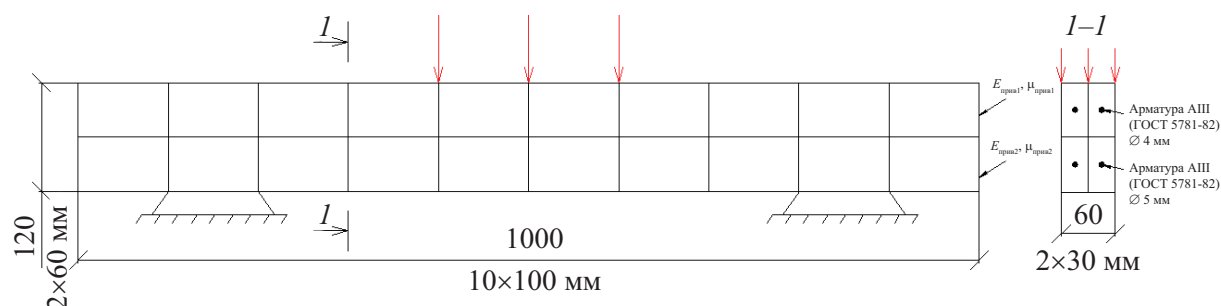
Конечноэлементная схема моделируемой железобетонной балки
